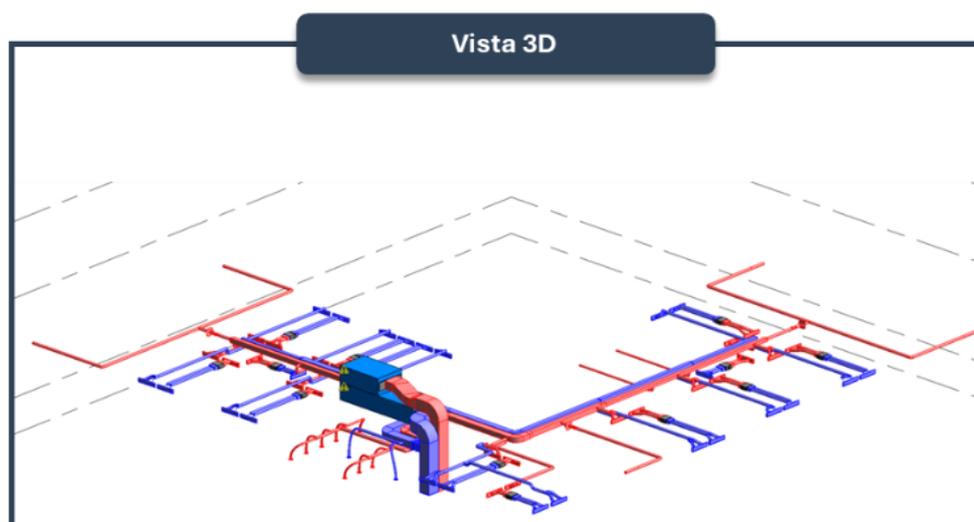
Rappresentazione impianto di ventilazione vista 3D
